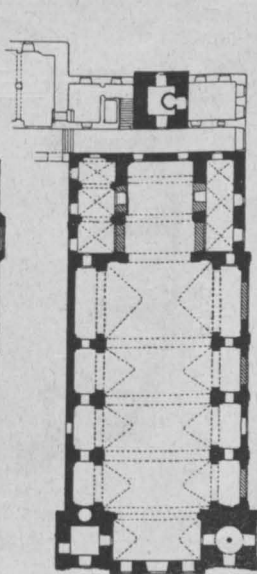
Grundriß der Schottenkirche, I. Bez.
